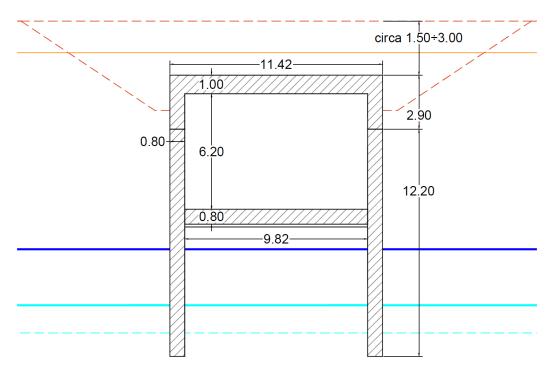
Esempio di sezione trasversale della galleria artificiale realizzata in trincea (GA2-GA3)
